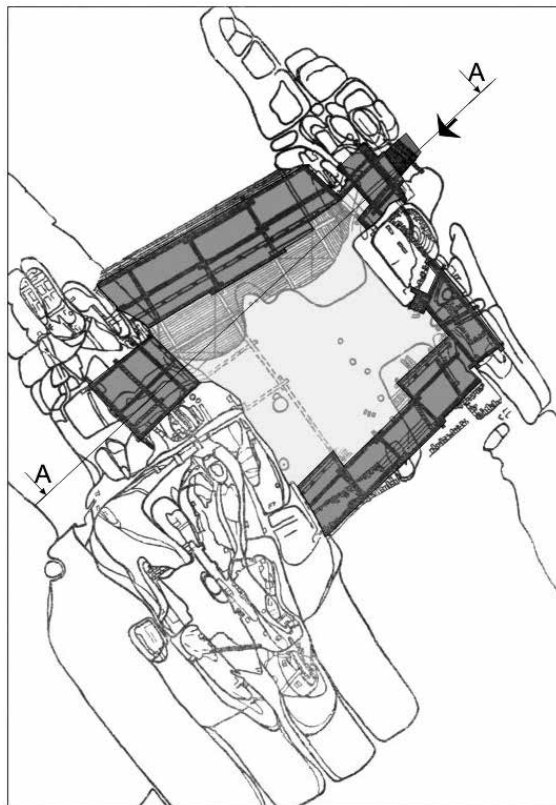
План дерев'яної забудови другого будівельного періоду. Реконструкція автора.
